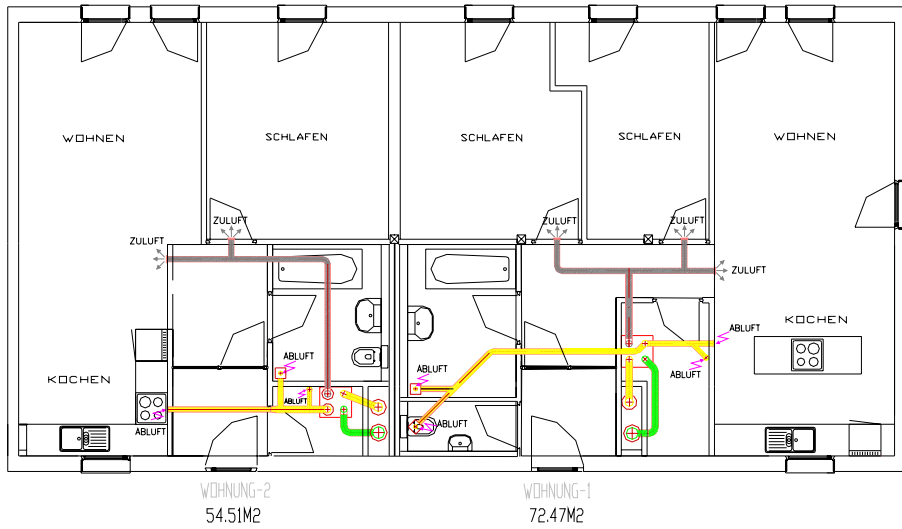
Haustechnik Grundriss, Projekt "Ölzbündt"
